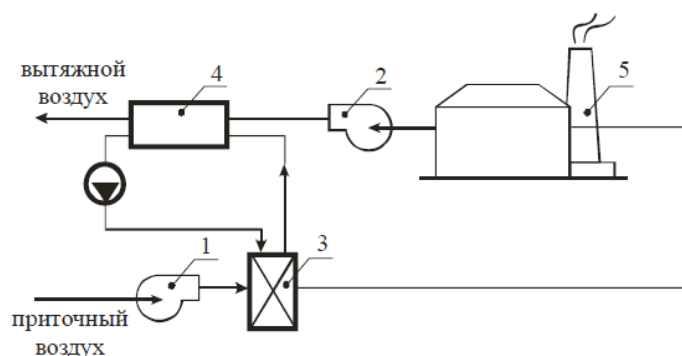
Схема применения теплового насоса для подогрева приточного воздуха в системе вентиляции:
